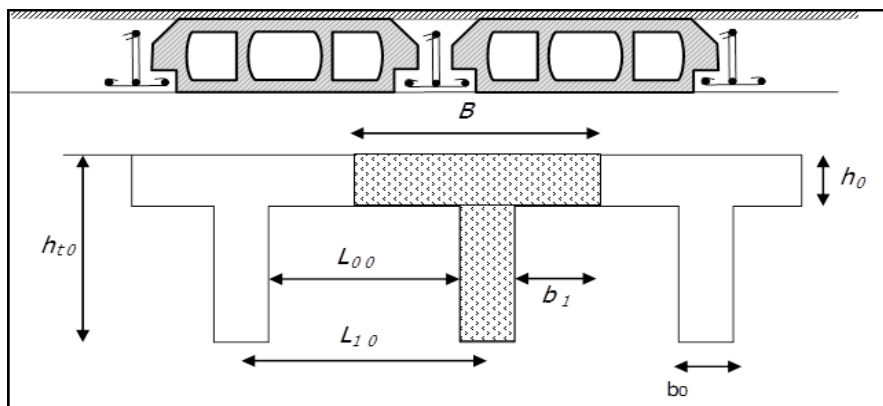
coupe d'un plancher à corps creux et schéma explicatif de la poutrelle.
